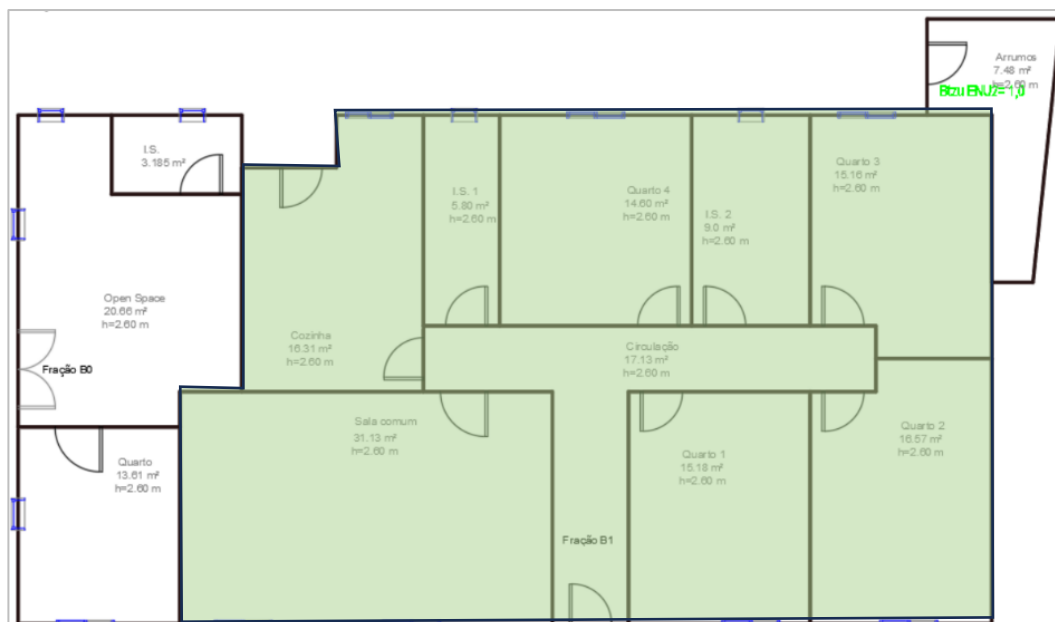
Planta do piso 0 (fração do caso de estudo em destaque, a verde)
